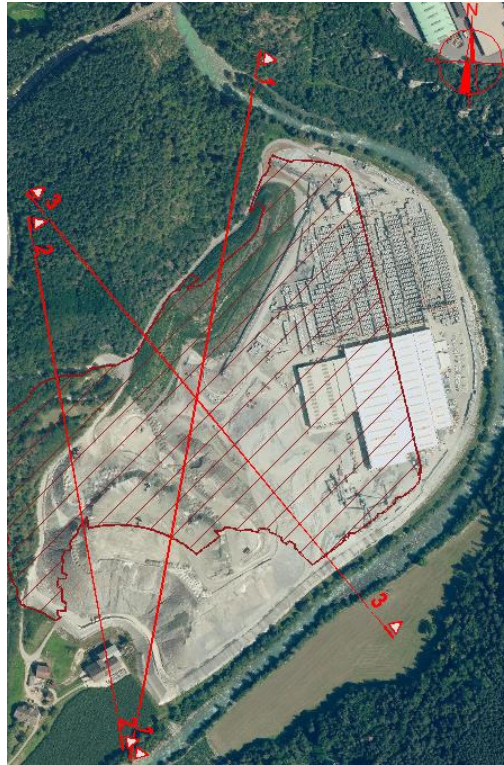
Vista in pianta del deposito di Hinterrigger con ubicazione delle sezioni di raffronto
